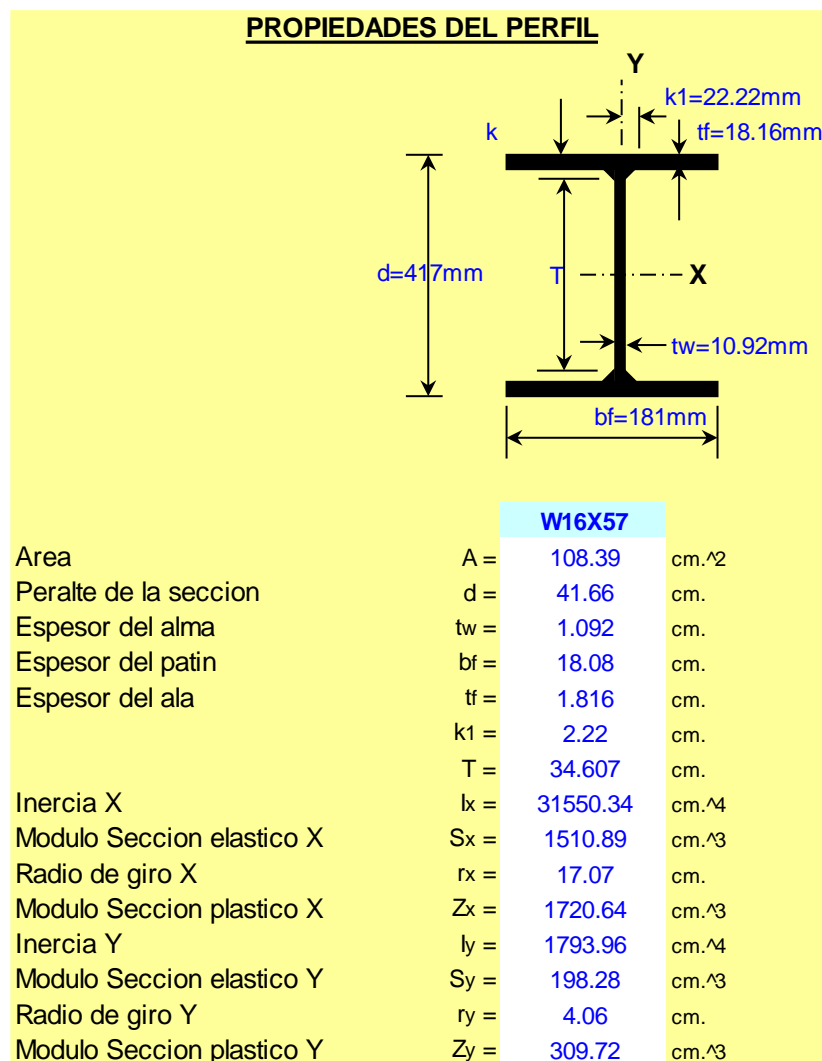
Propiedades del perfil -Viga de Acero – eje B.- Sistema estructural mixto.
